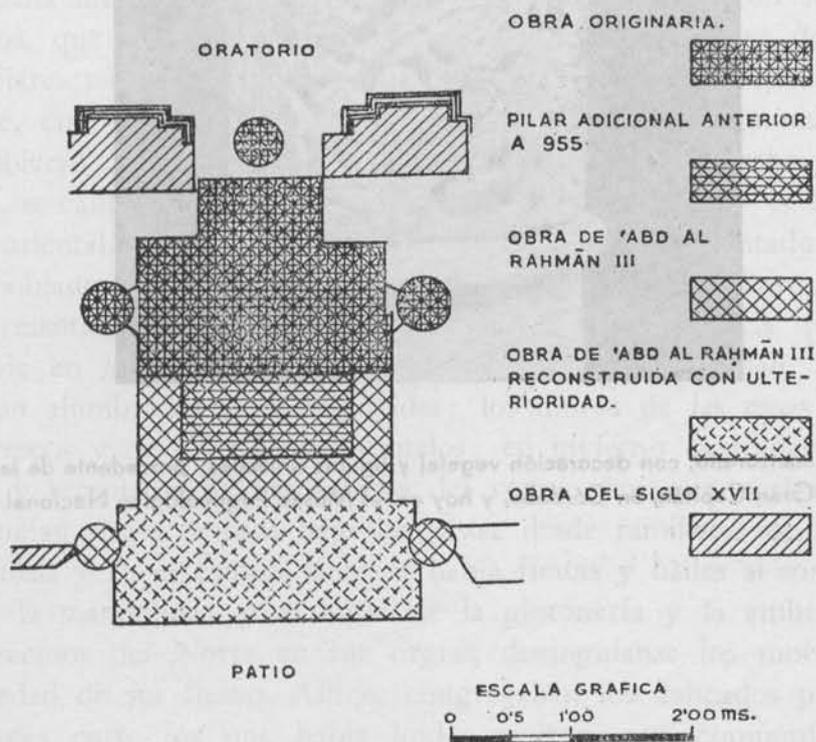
Mezquita Mayor de Córdoba, planta del pilar de la fachada N. del Oratorio comprendido entre las dos naves del edificio originario situadas más al E
